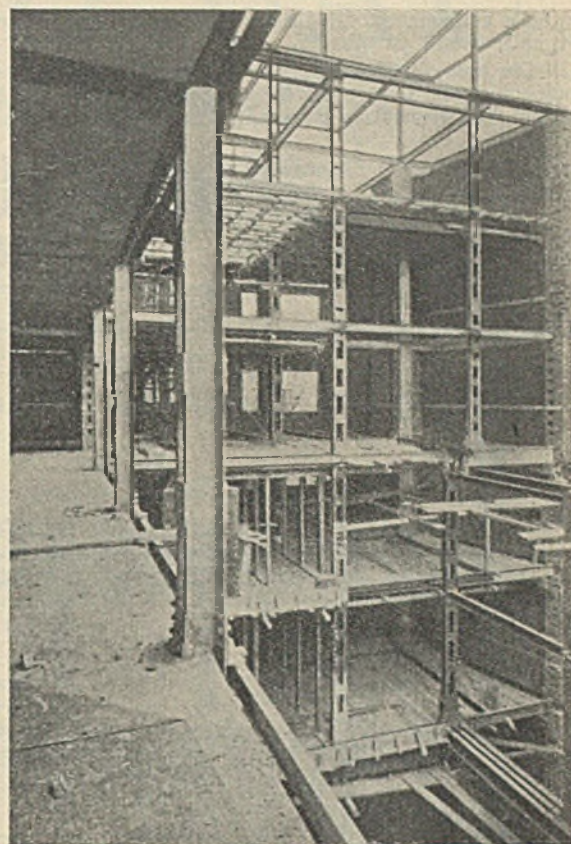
Stahlskelett mit teilweise einbetonierten Decken.
